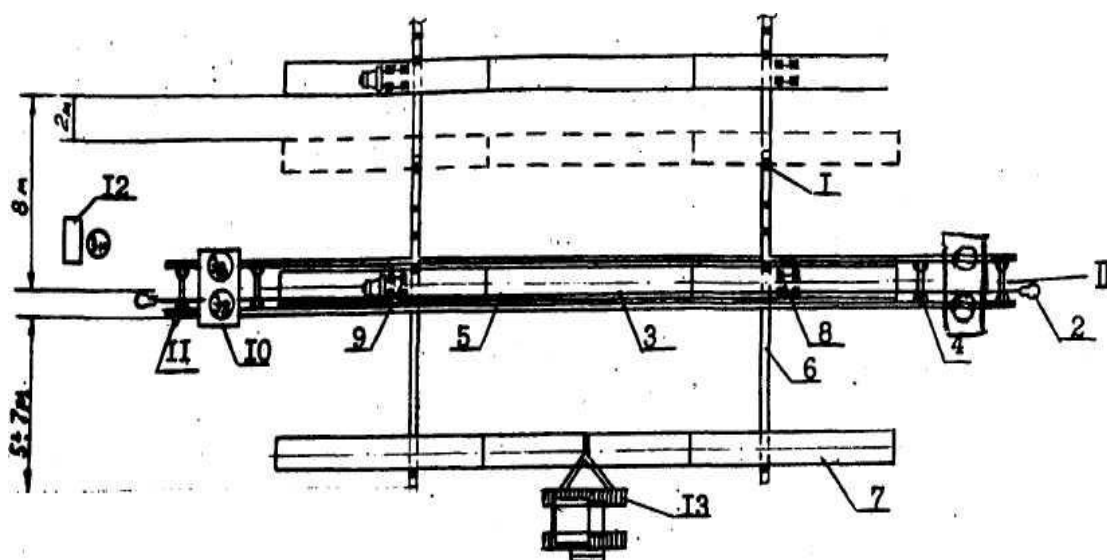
Исходное положение сварочных постов
